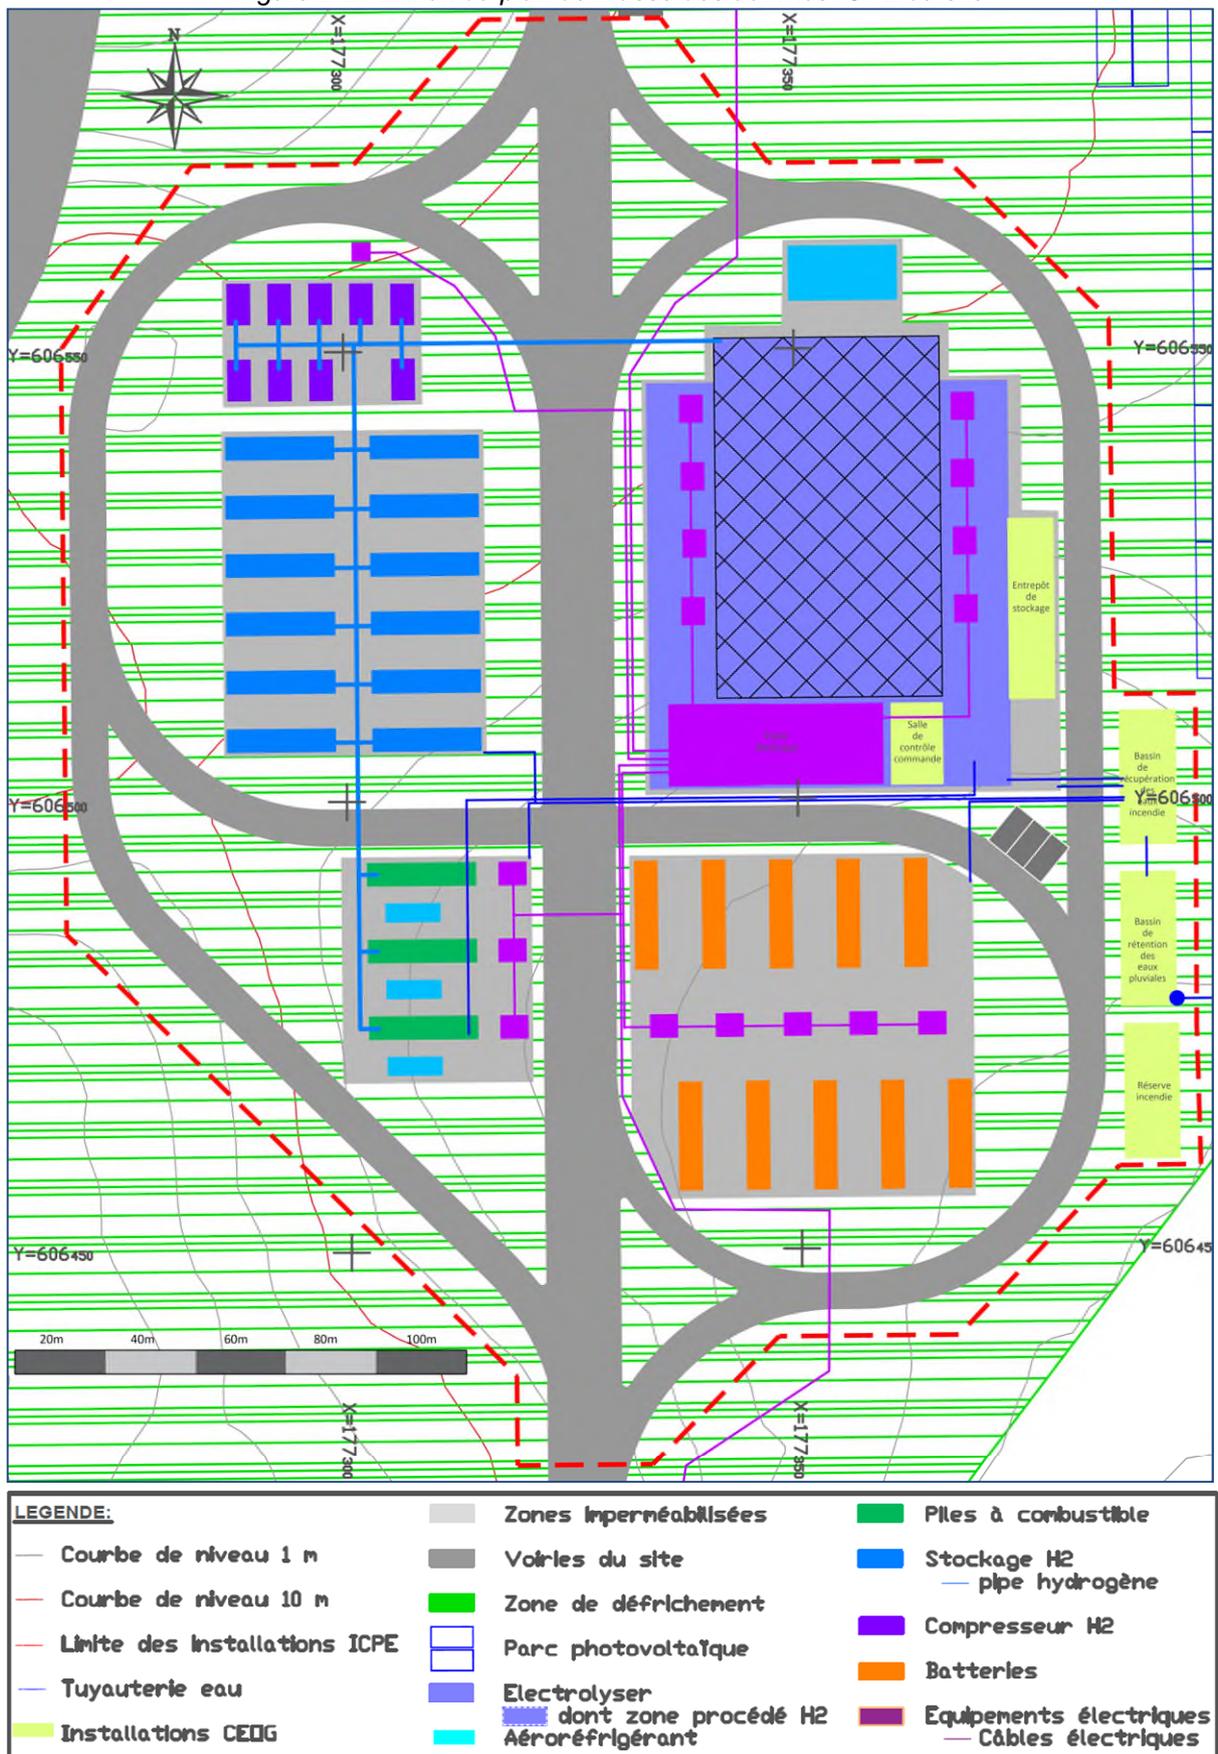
Extrait du plan de masse des activités ICPE du site
